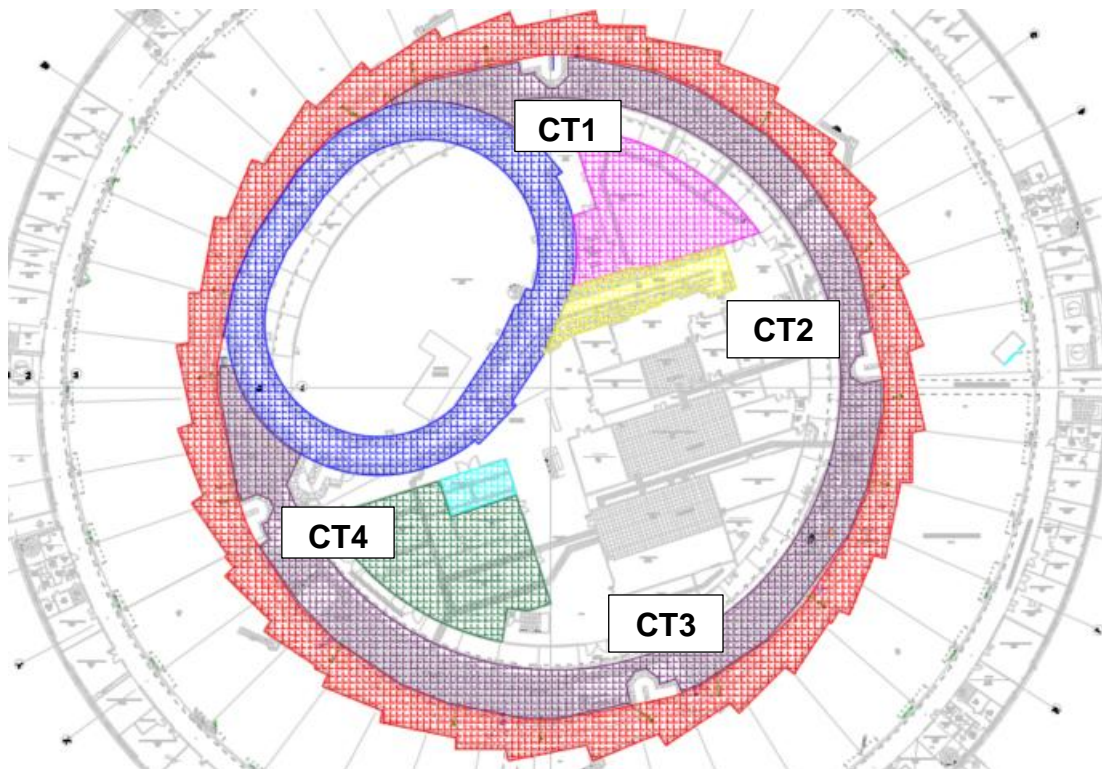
Extrait du plan de repérage - en rouge le tunnel de l'anneau de stockage
